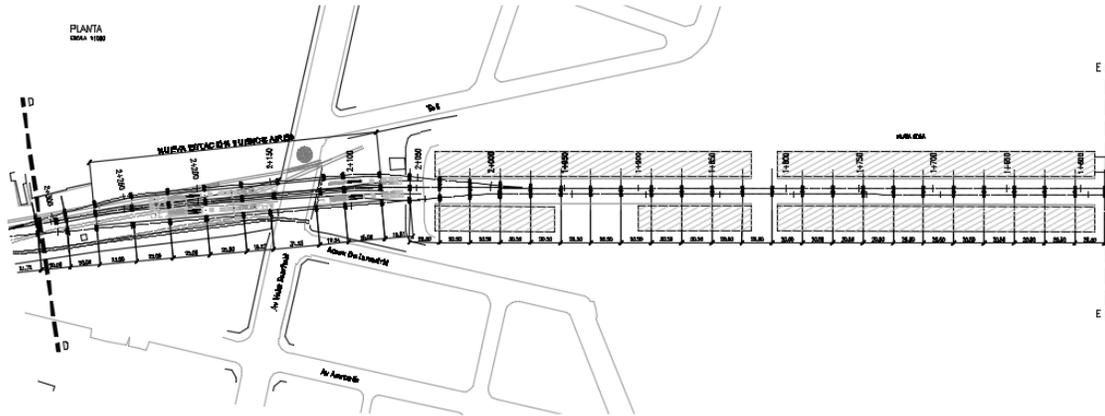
Tramo Estación Buenos Aires Elevada – Playa Sola
